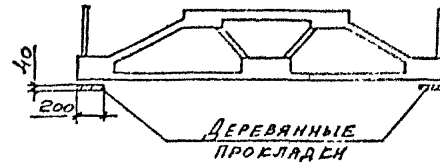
СХЕМА ОБИРАНИЯ ФЕРМЫ ПРИ ХРАНЕНИИ И ПЕРЕВОЗКЕ
